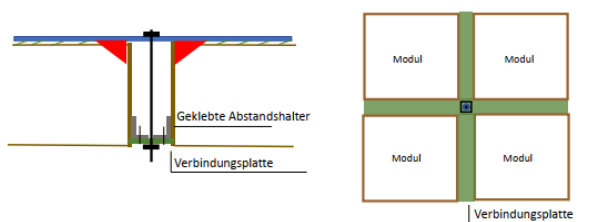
Verbindungsprinzip 1 - im Schnitt und Grundriss
